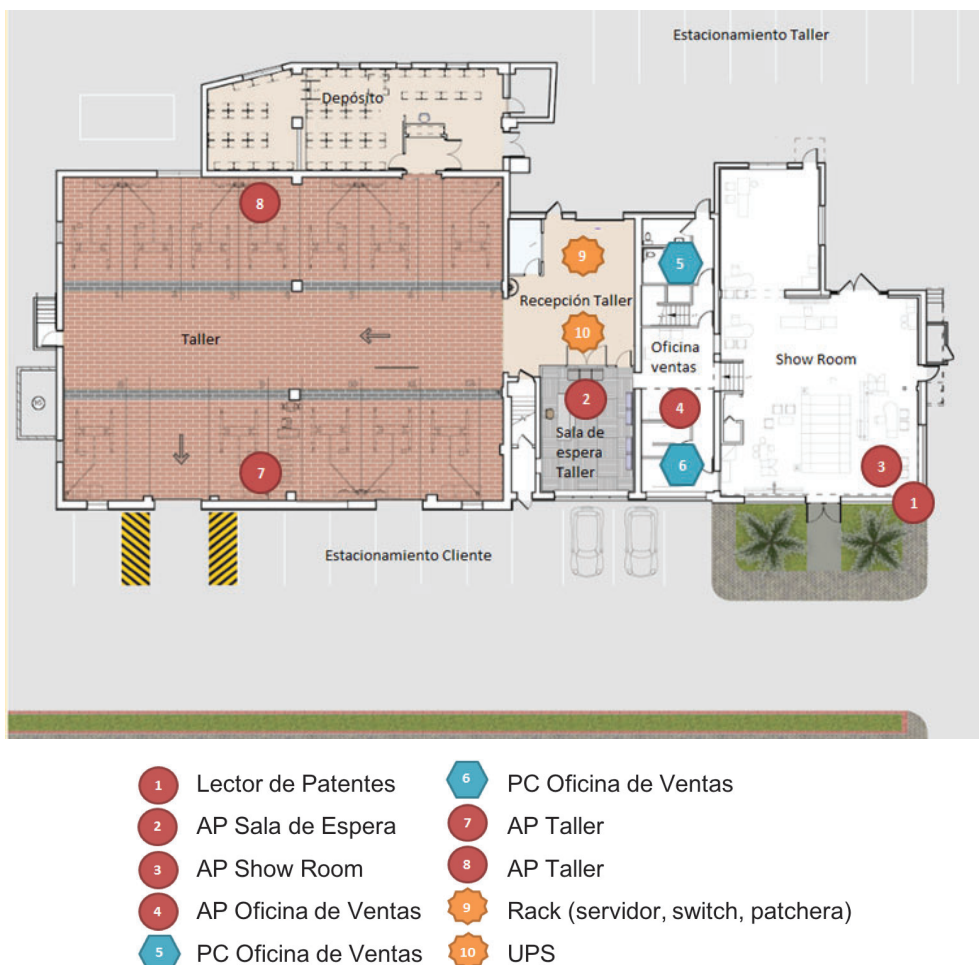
Plano esquemático del concesionario con distribución de dispositivos
